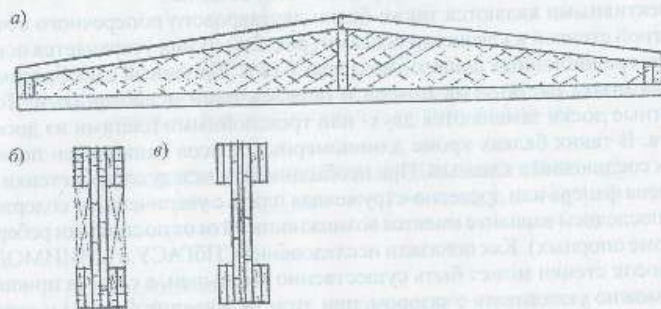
Дощато-гвоздевая балка с клееными поясами: а – общий вид балки; б – поперечное сечение с обычной двухслойной стенкой; в – поперечное сечение с трехслойной стенкой (доски, листовый материал)
